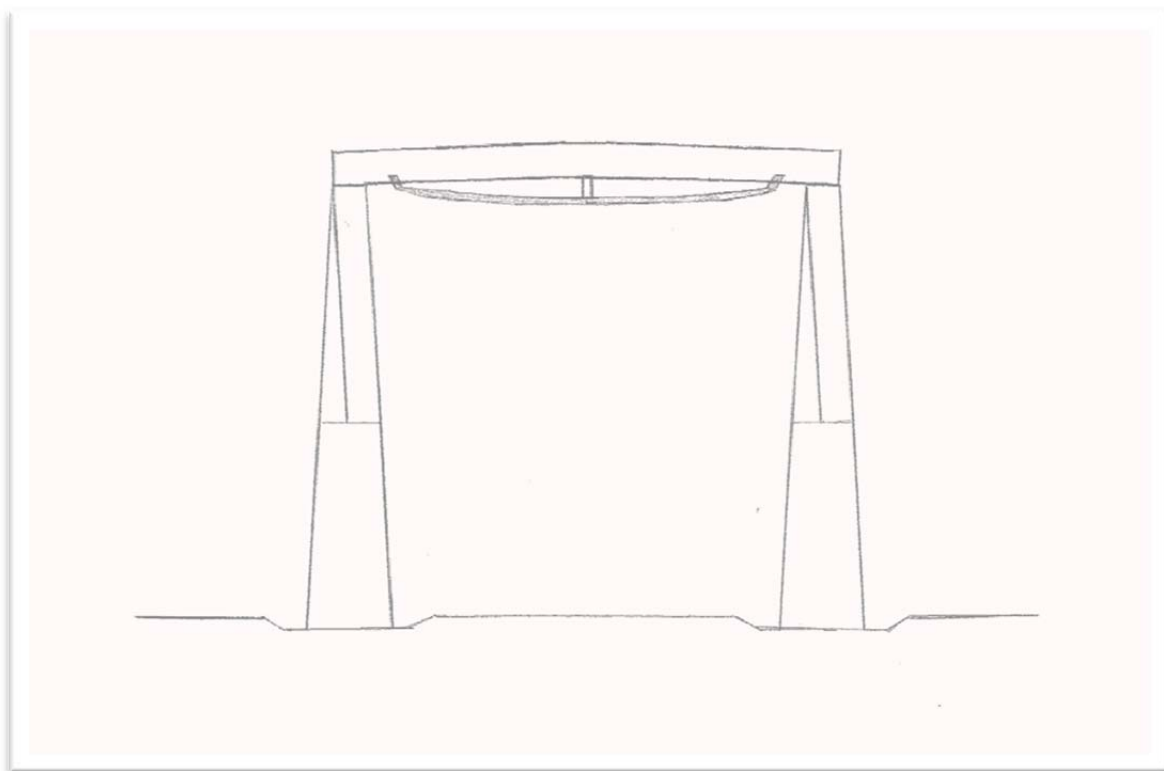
Studerad plansilo i trä med gjutna, brädklädda väggar (4,5 m betonghöjd). Dimensioner: Lagringshöjd: 4,5 m, bredd: 3 x 8 m, längd: 35 m.
